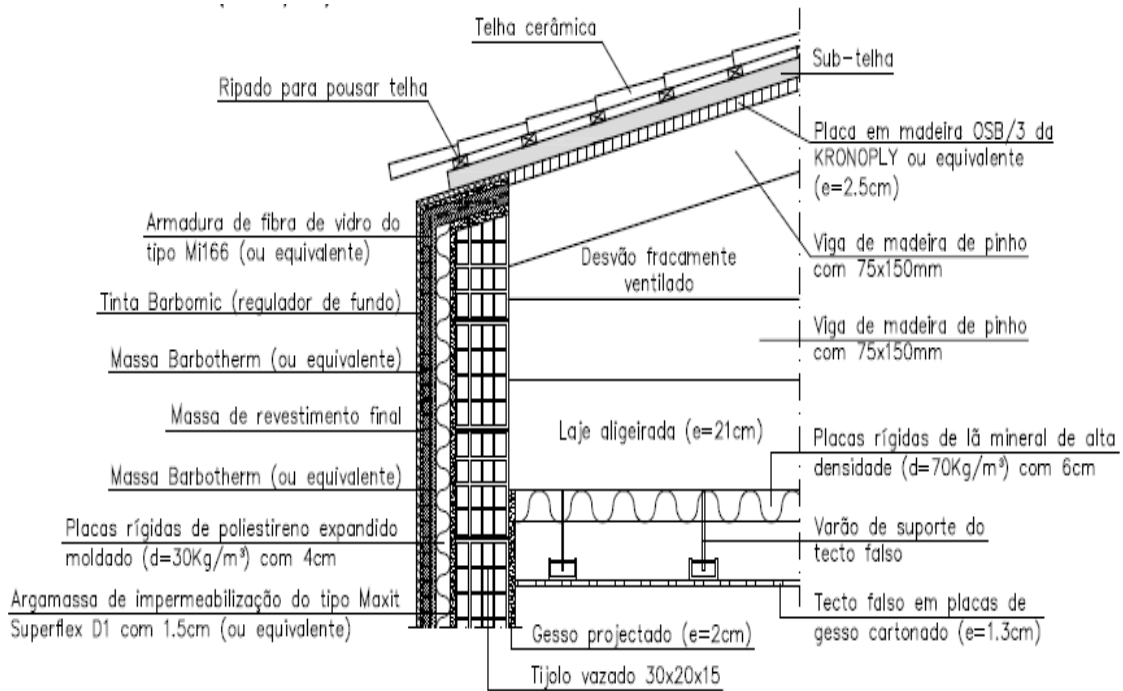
Pormenor da ligação da fachada com a cobertura
